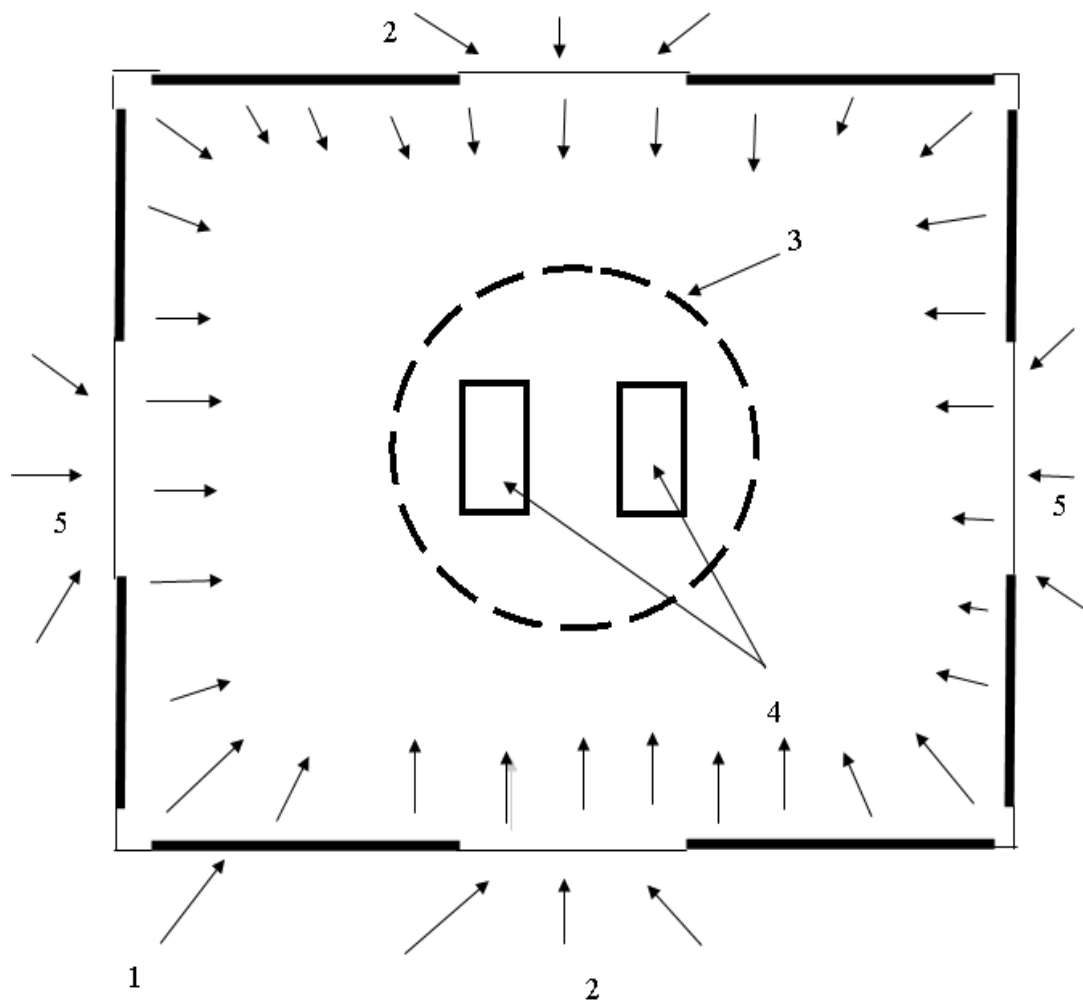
Вентиляционные проемы в стене надшахтном здании (копра) :
